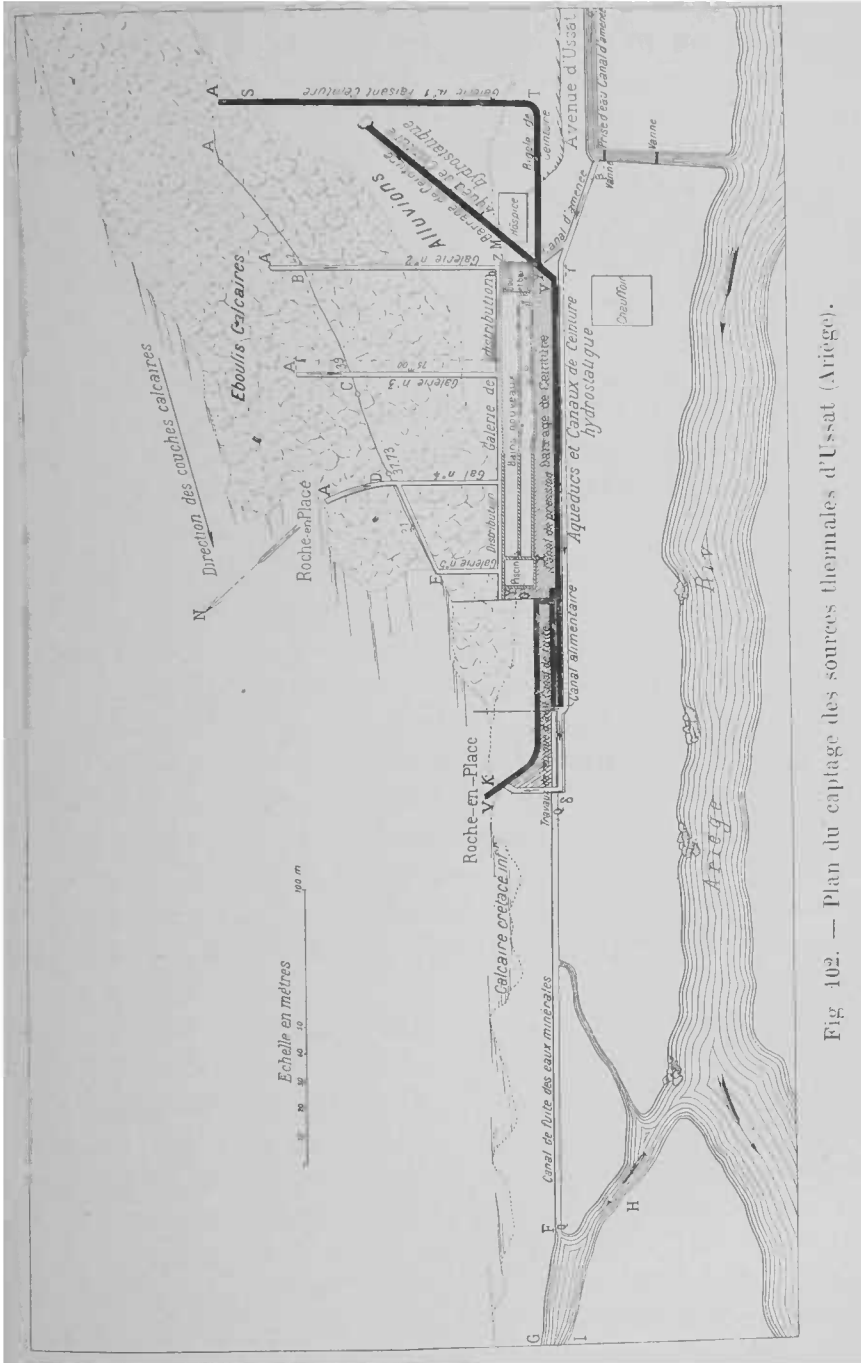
Plan du captage des sources thermales d'Ussat (Ariège).
